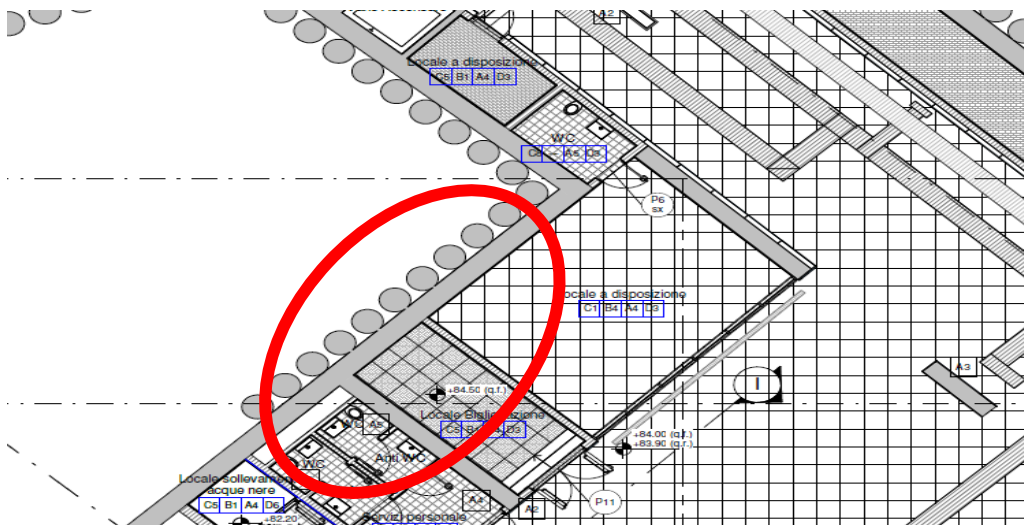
Area di connessione corridoio Stazione EAV – Piano Atrio a quota 84.5
